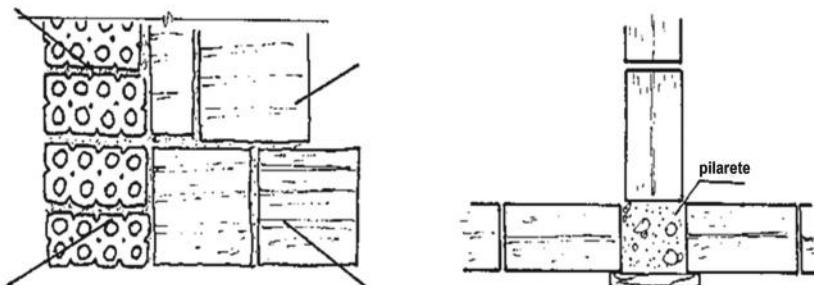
Exemplo de amarração nas alvenaria de tijolo furado.
